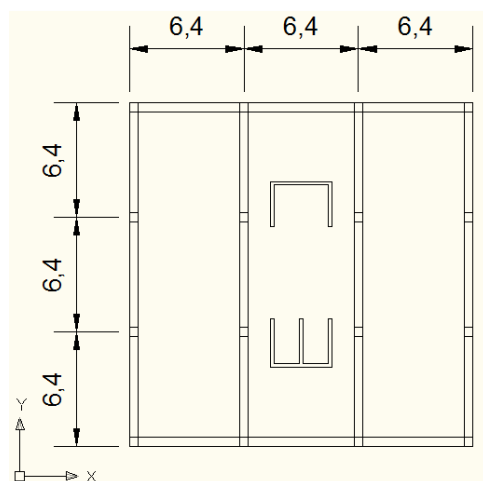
Esquema da planta do edifício (dimensões em metros)
